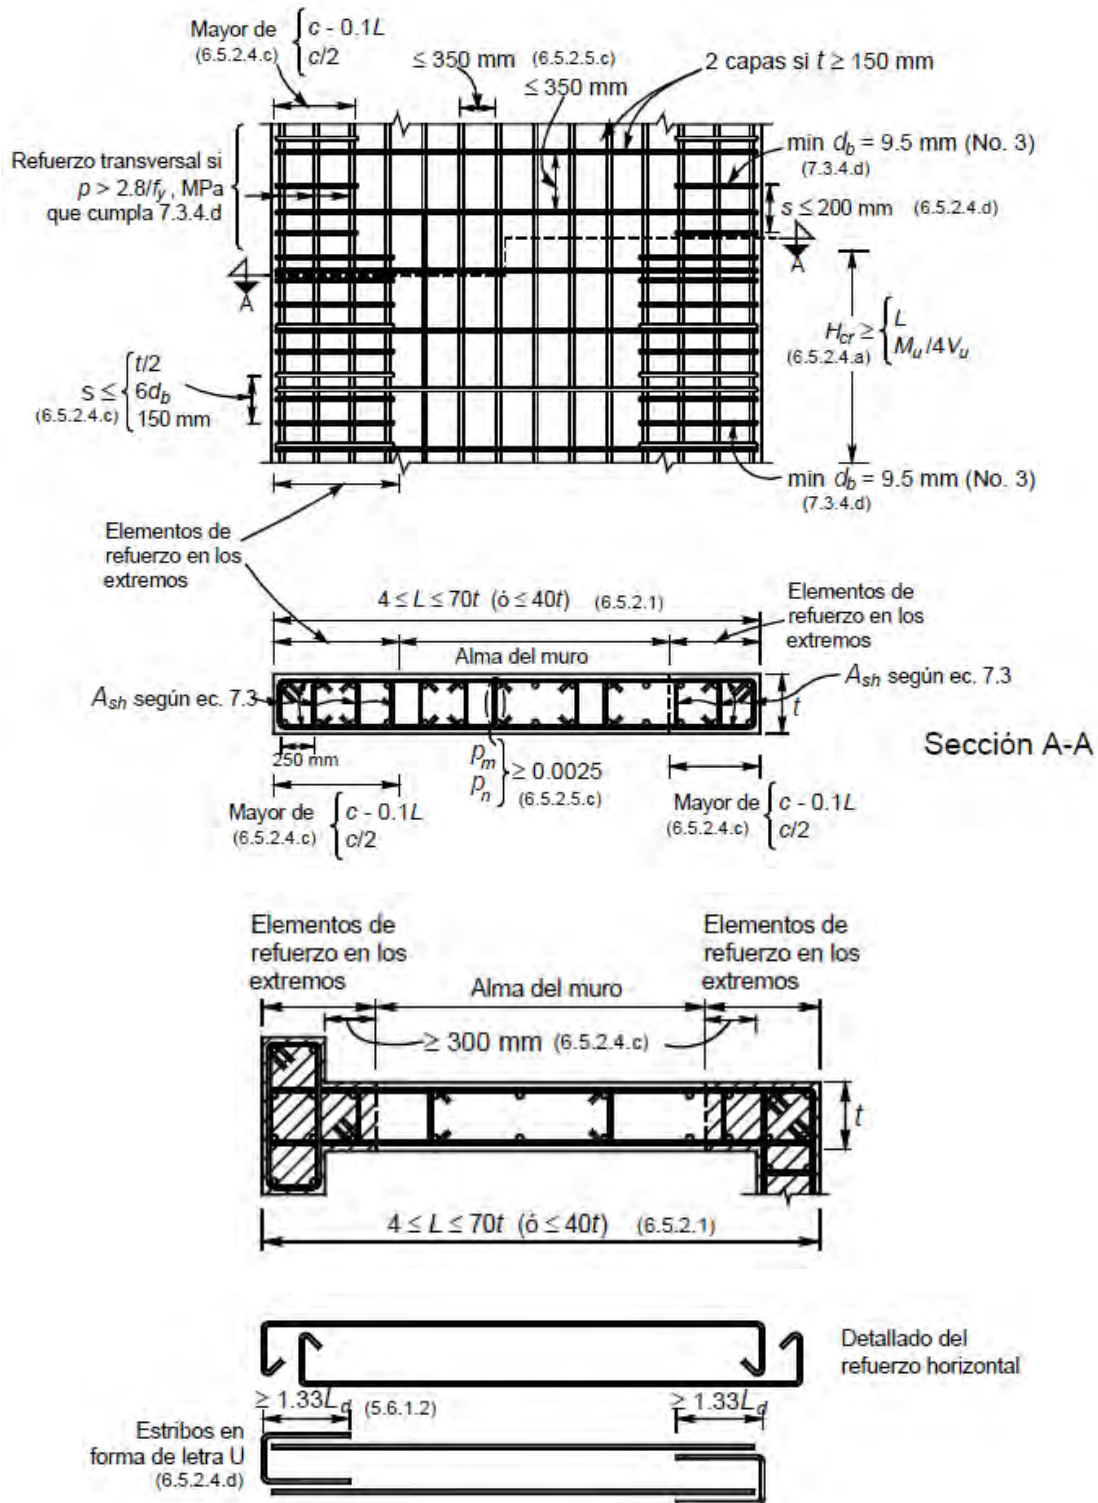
Detalle de armado para muros de concreto NTCC-2004
